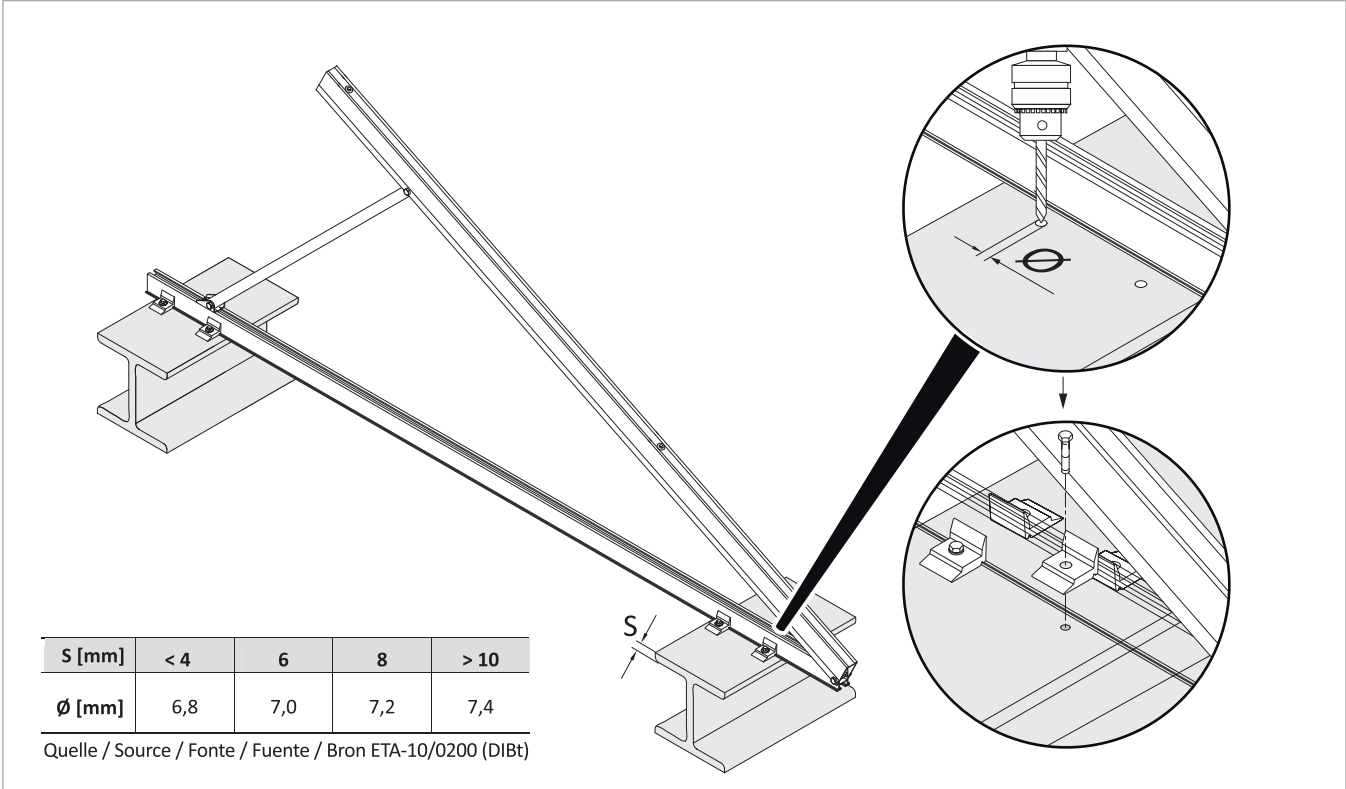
Montaje del soporte para tejado plano sobre vigas de acero con tornillos autorroscantes (juego de soportes para tejado plano MUK)
